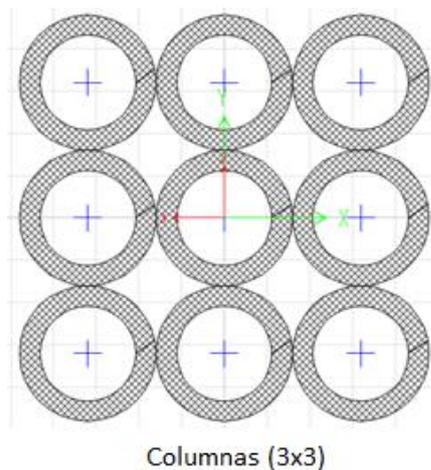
Sección transversal de columnas. Fuente: Propia
